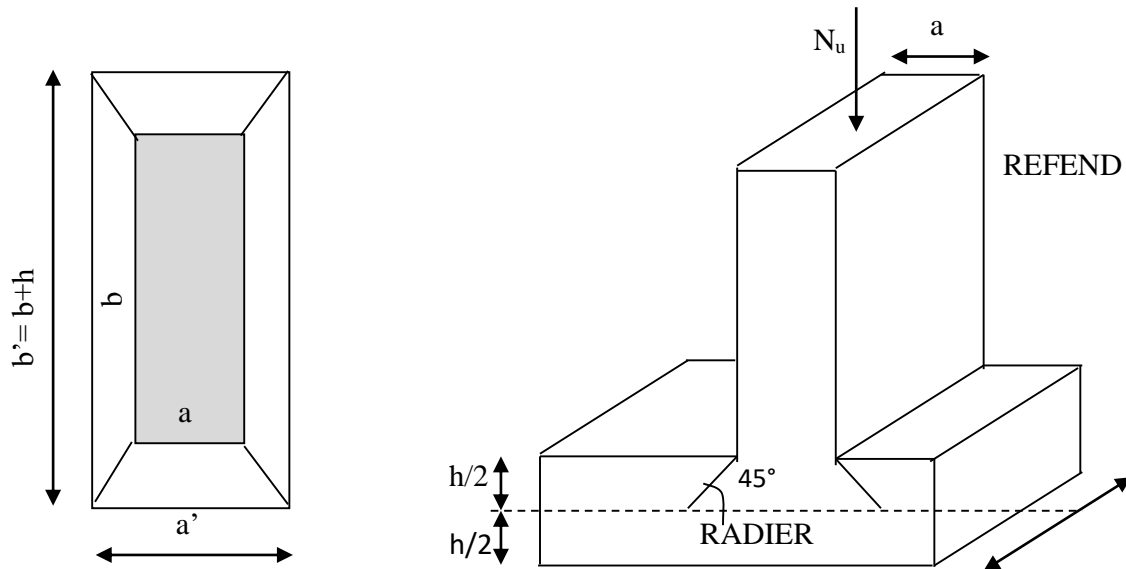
Périmètre utile des voiles et des poteaux.
